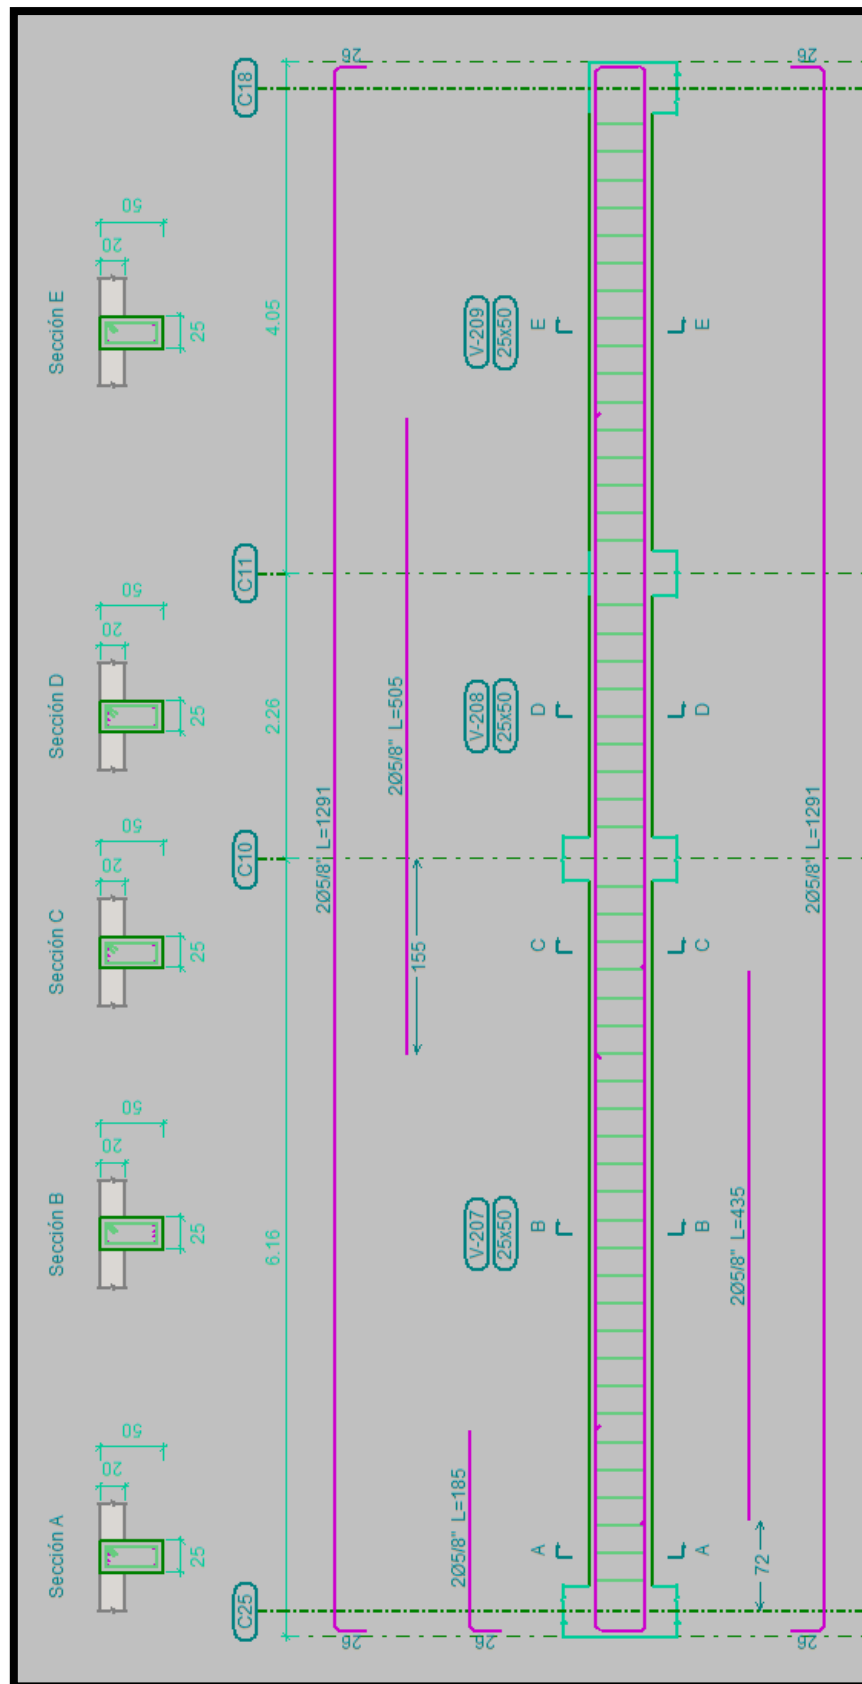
Detalle de vigas principales módulo 1 y 2.
